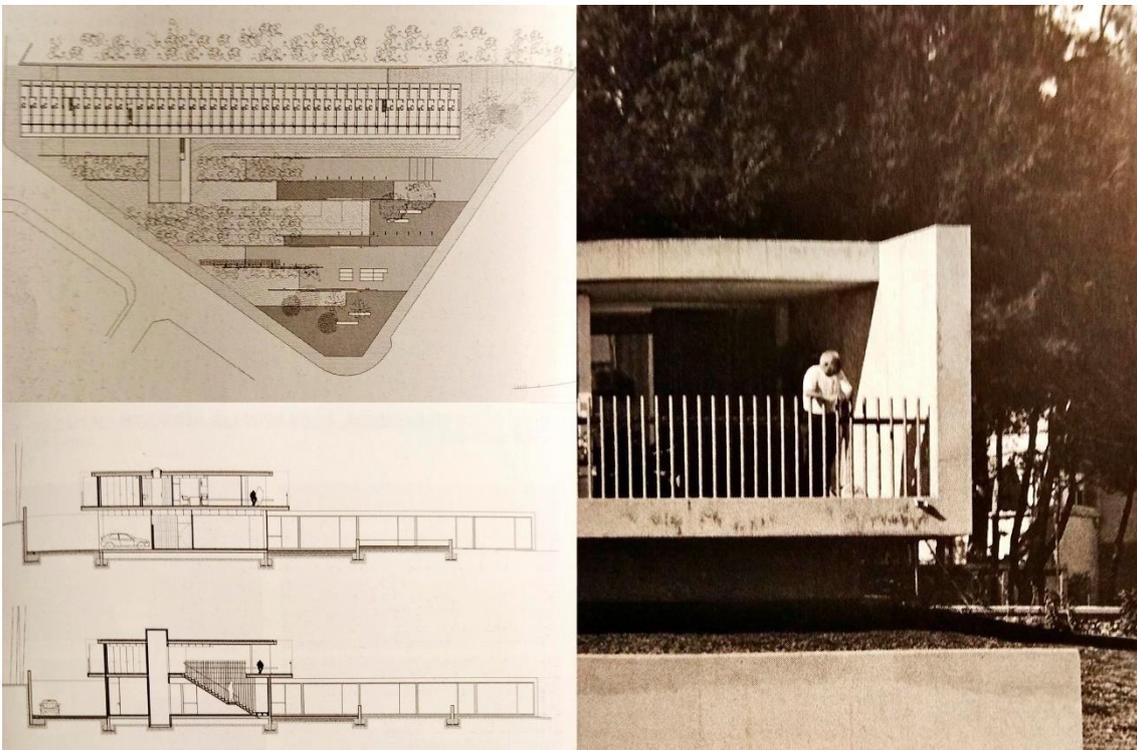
Planta viviendas y jardín, sección viviendas y vista exterior.
